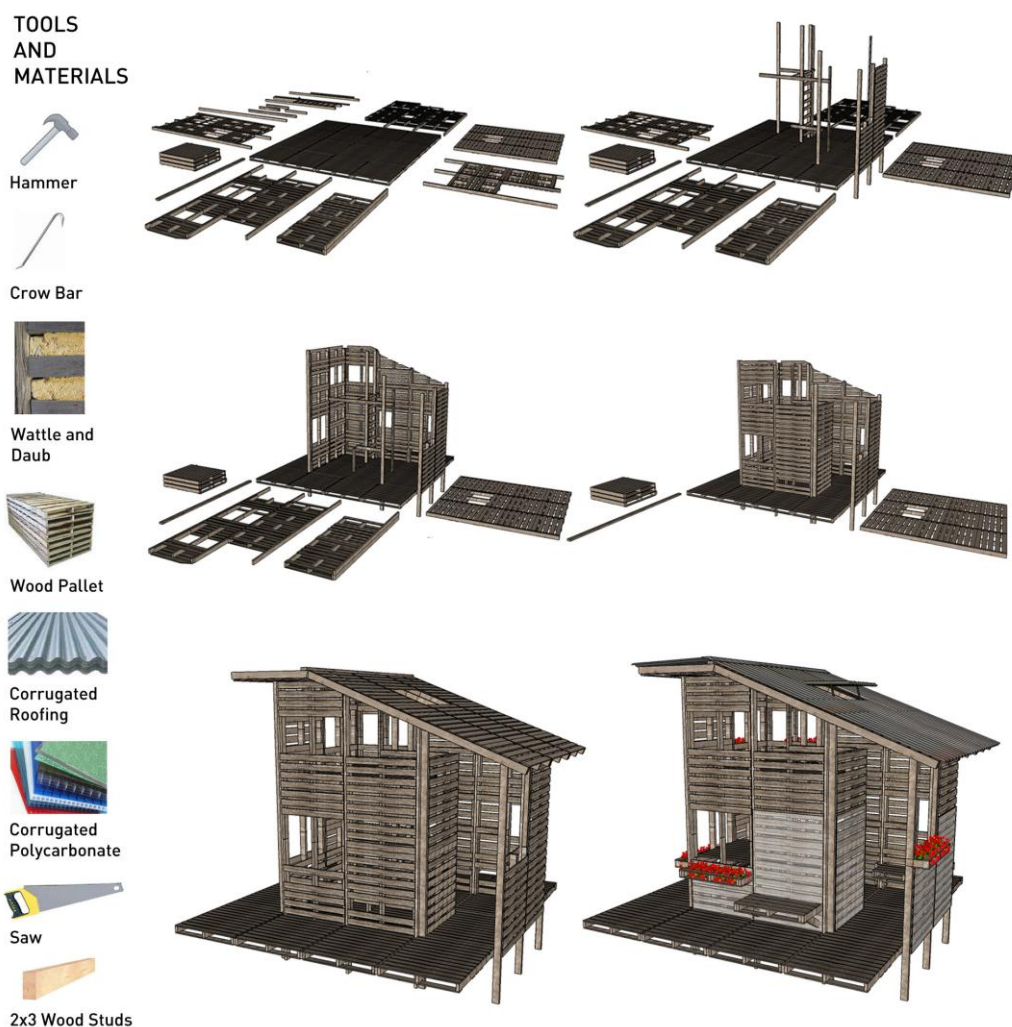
Kit de instruções da «Pallet House». (BFI, 2010).
